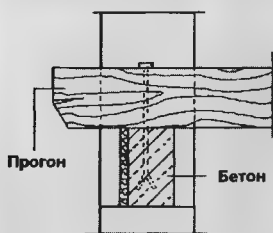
В качестве опоры для первого и среднего прогона укладывают U-образные блоки и заполняют их раствором. Они препятствуют образованию трещин на стенах, которые могут возникнуть вследствие повышенной нагрузки, вызываемой стропильной конструкцией
